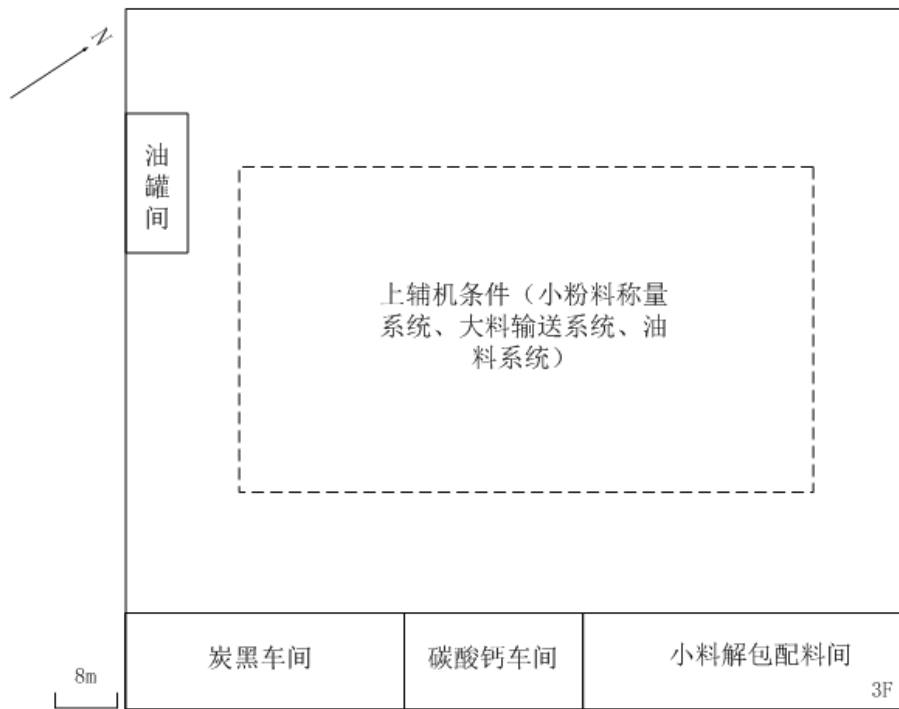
项目炼胶车间 3F 平面布置 (变动前)
